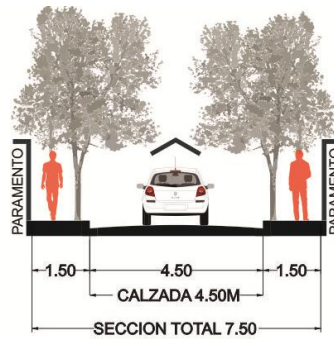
Sección Acceso a Colonia un carril de circulación.
